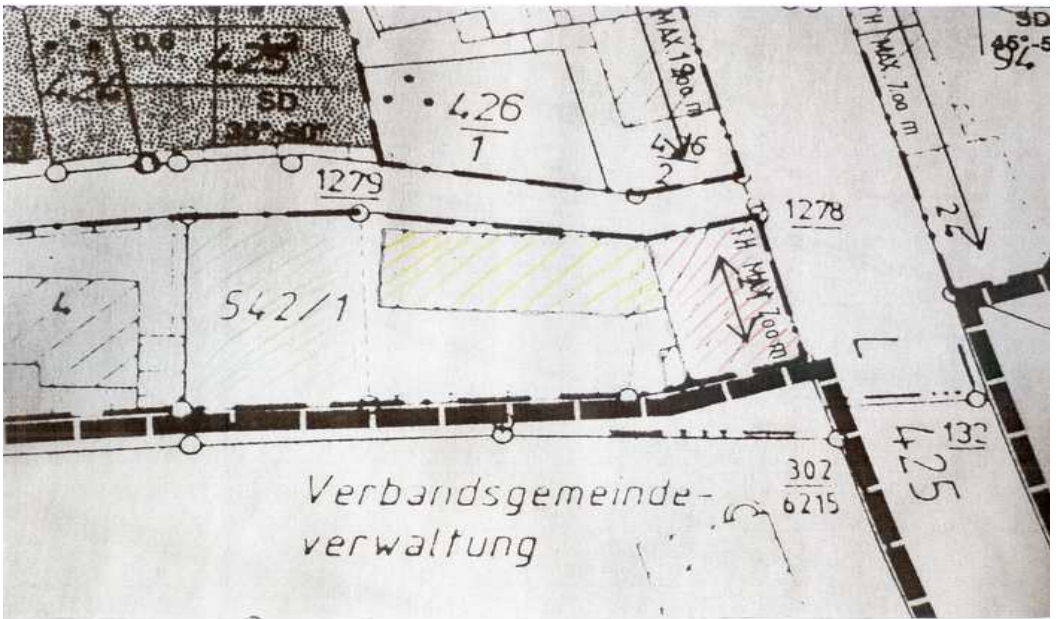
Lageplan 1996 Kindergarten mit Anbau von 1957 und Garten Nr. 542/1
